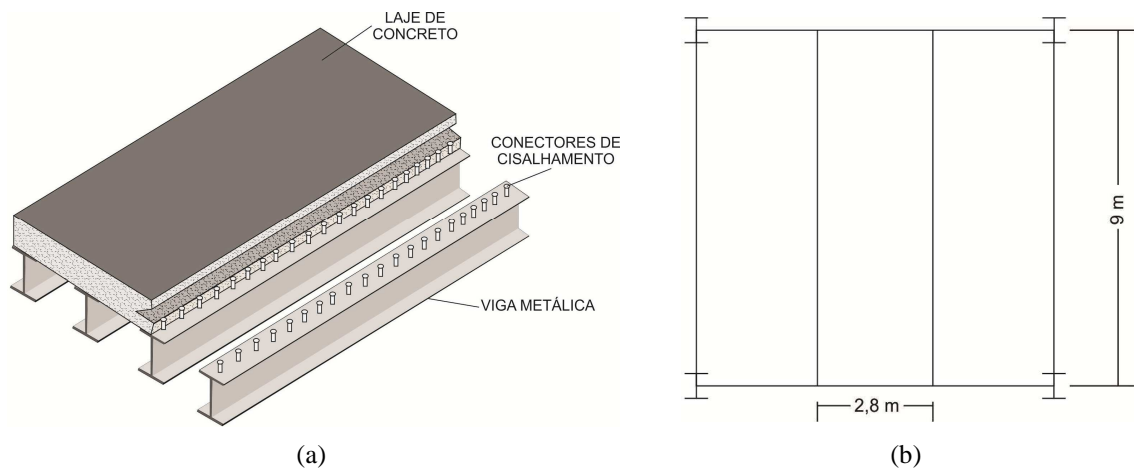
Viga mista do estudo de caso 1: (a) Vista tridimensional; (b) Vista superior.
